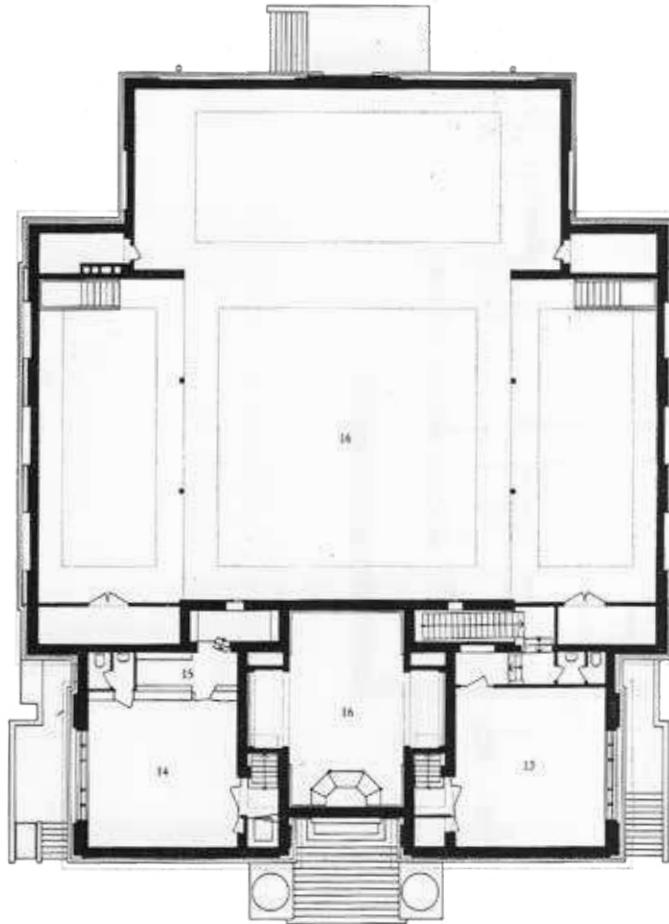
Grundriss Obergeschoss, Maßstab ca.1:350, 1986
